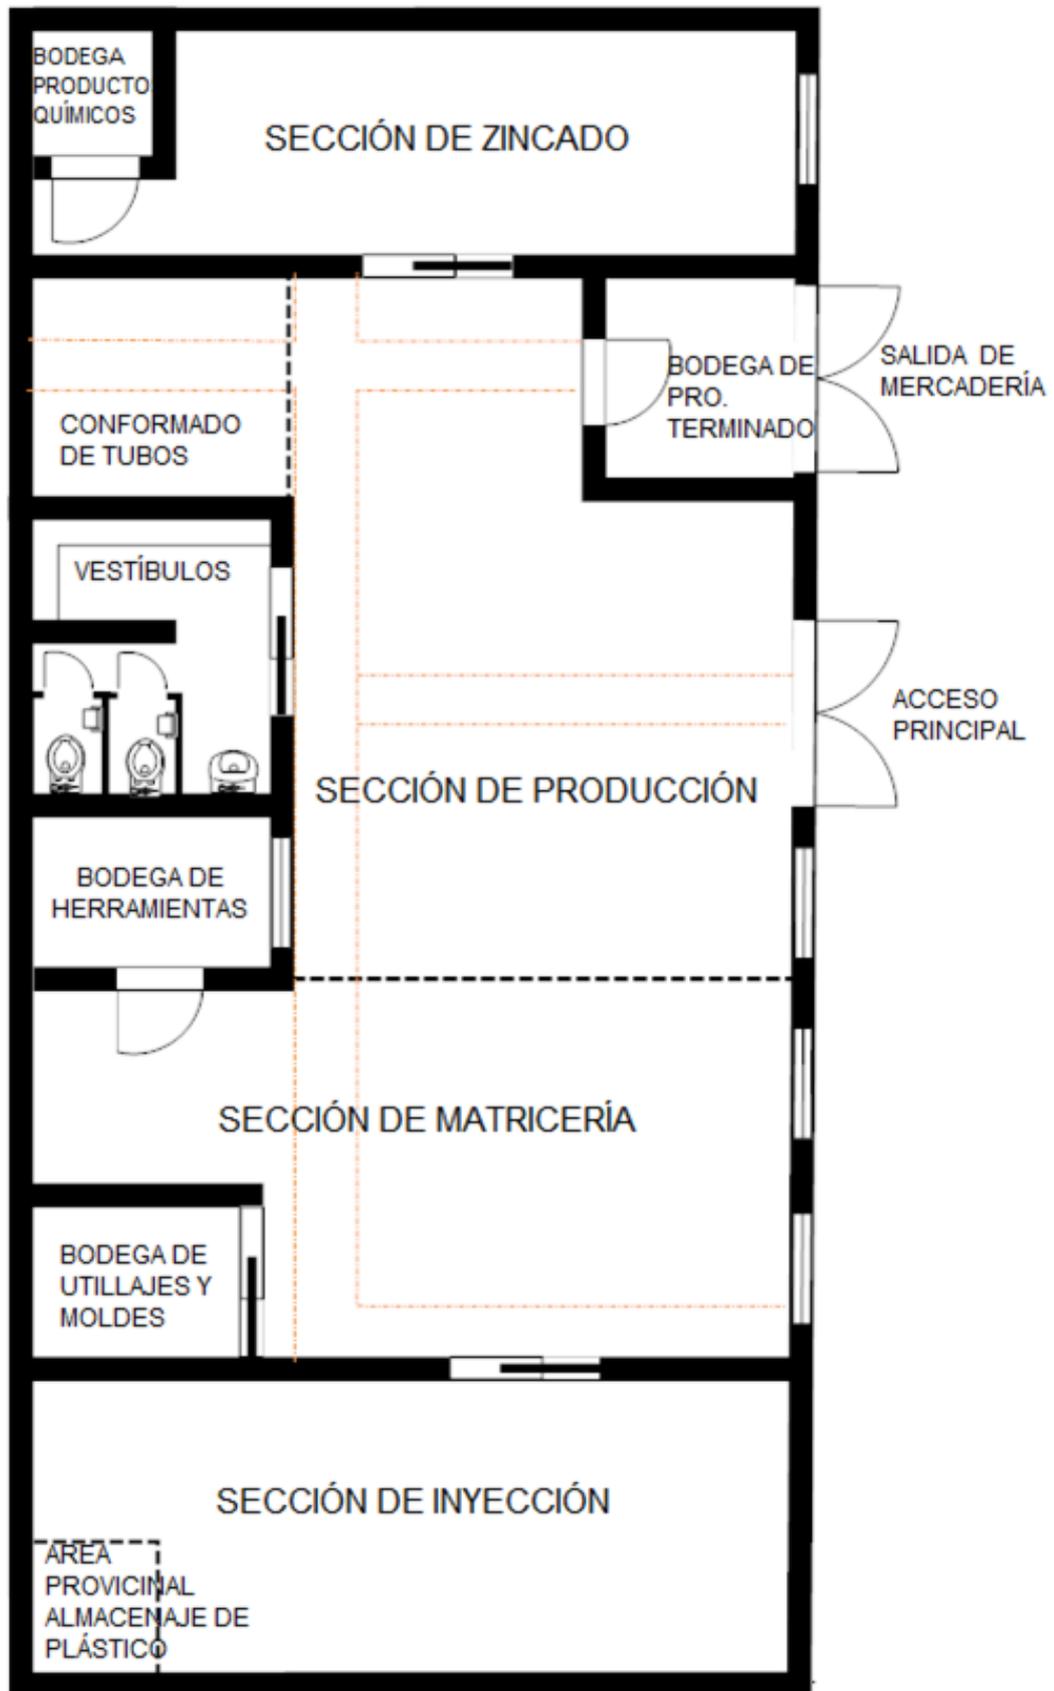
Distribución Ideal propuesta Para la Sección de Plástico.
